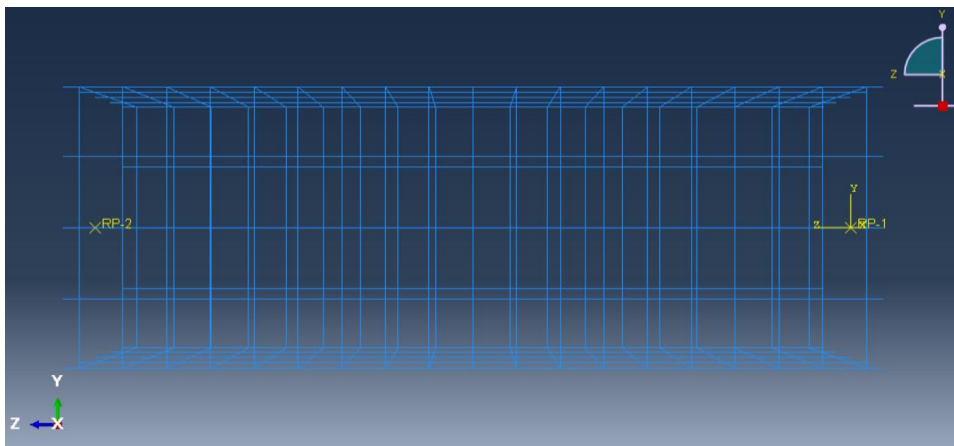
Pormenor construtivo da armadura da viga A2 com modelo modificado
